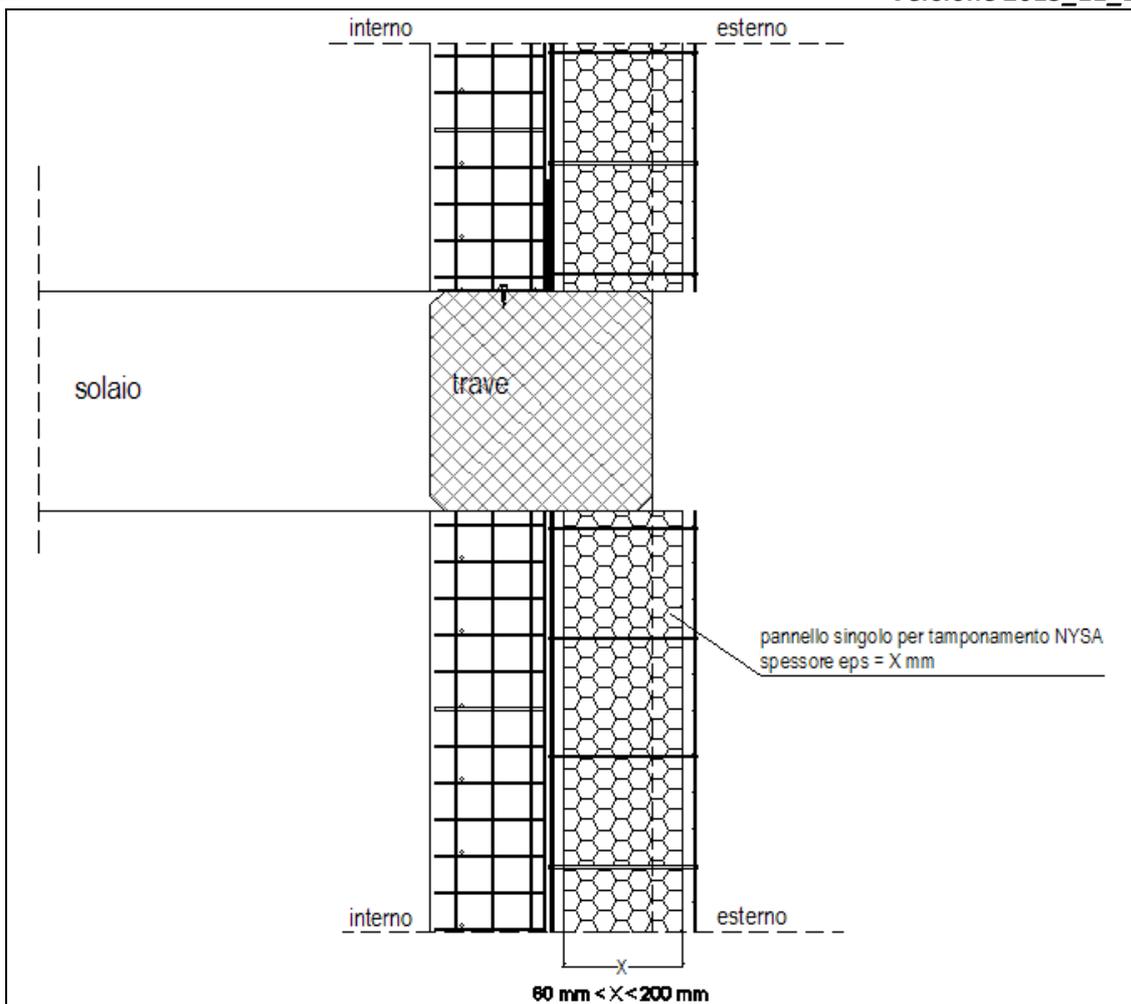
Fase 2 – Caso B: sezione verticale del collegamento.
